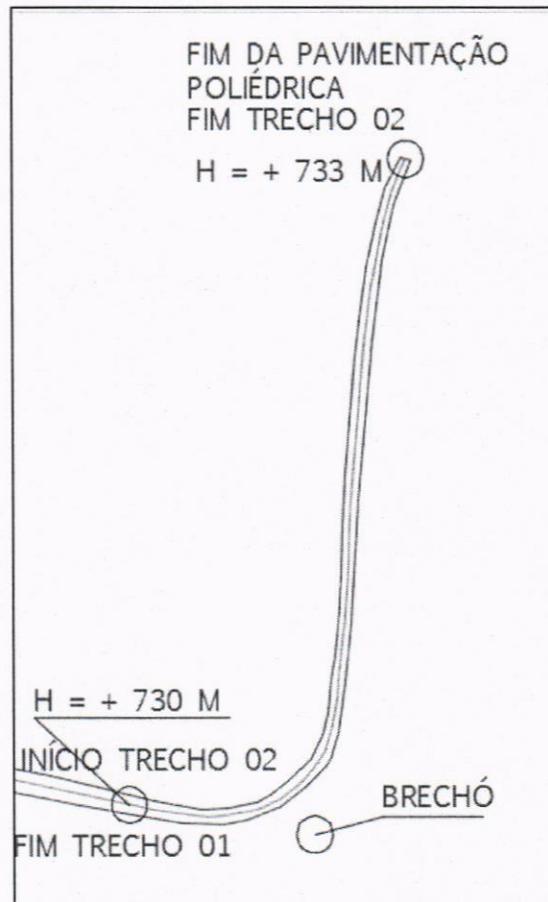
Perfil Longitudinal do Pavimento - Cruzamento
